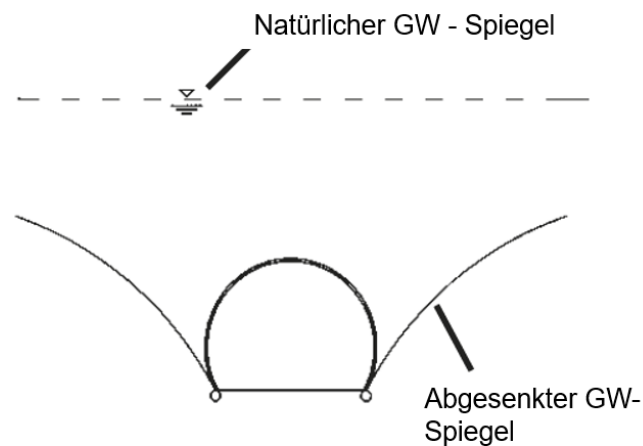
Drainierter Tunnel mit drucklosen Abfluss (Maidl et al., 2014)
